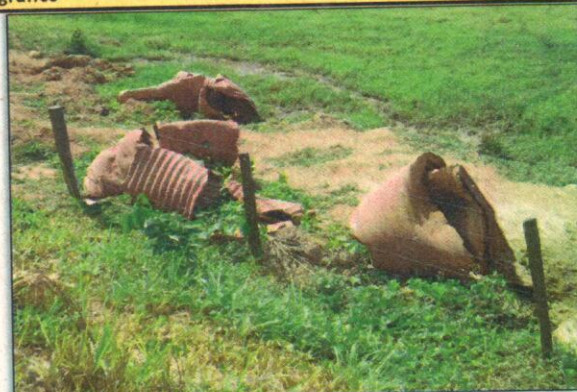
Bueiro armco faixa de domínio. Lado esquerdo.
